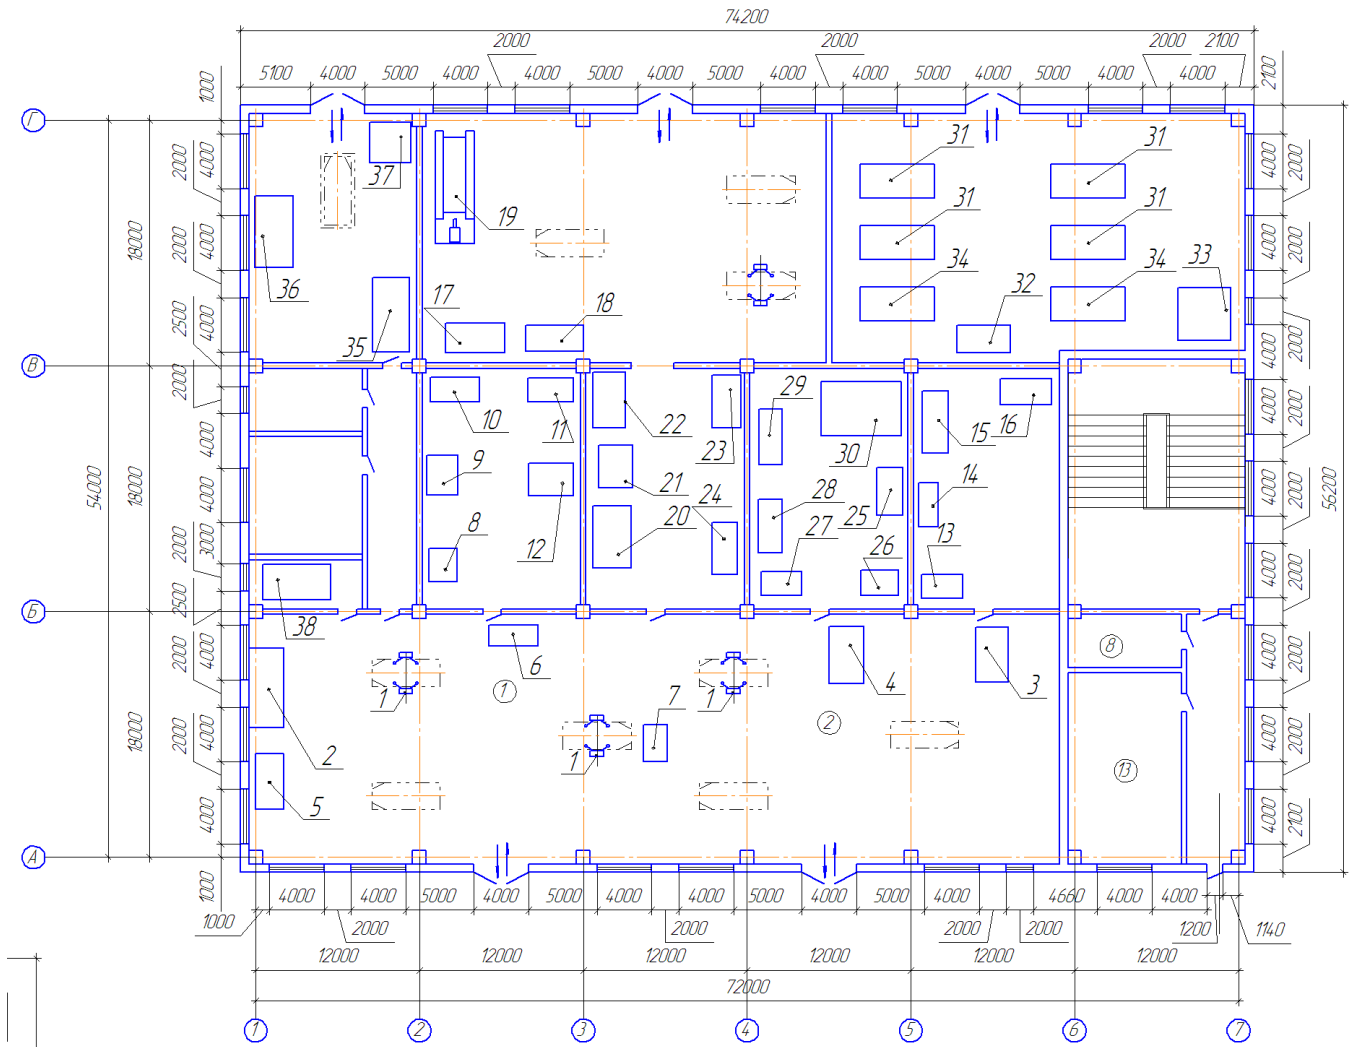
Розміщення обладнання: 1 - двохстійковий підйомник; 2 – верстак; 3 – установка для змащення; 4 – пневматичний оливороздавач; 5 – пристрій для проточування; 6 - візок для коліс; 7 - пристрій для прокачки гальм; 8 - стенд для шиномонтажу; 9 - стенд для балансування; 10 - стенд для ричхтування ; 11 – уулканізатор; 12 – ванна; 13 – стілаж; 14 - стенд інжекторів; 15 - верстат для карбюратора; 16 – верстак; 17 – стілаж; 18 – завр. апарат; 19 - стіл складальний; 20 – хонінгувальник; 21 – піч; 22 – станок; 23 – свердлильний станок; 24 - стапель; 25 - верстат заклепувальний; 26 - стенд для електрообладнання; 27 - точило; 28 – ПЗП; 29 – верстак; 30 - шафа для АКБ; 31 - камера для фарбування; 32 – шафа; 33 - Бокс для фарби; 31 – сушилка; 35 – порохотяг; 36 – мийка; 37 – насос; 38 – компресор.
